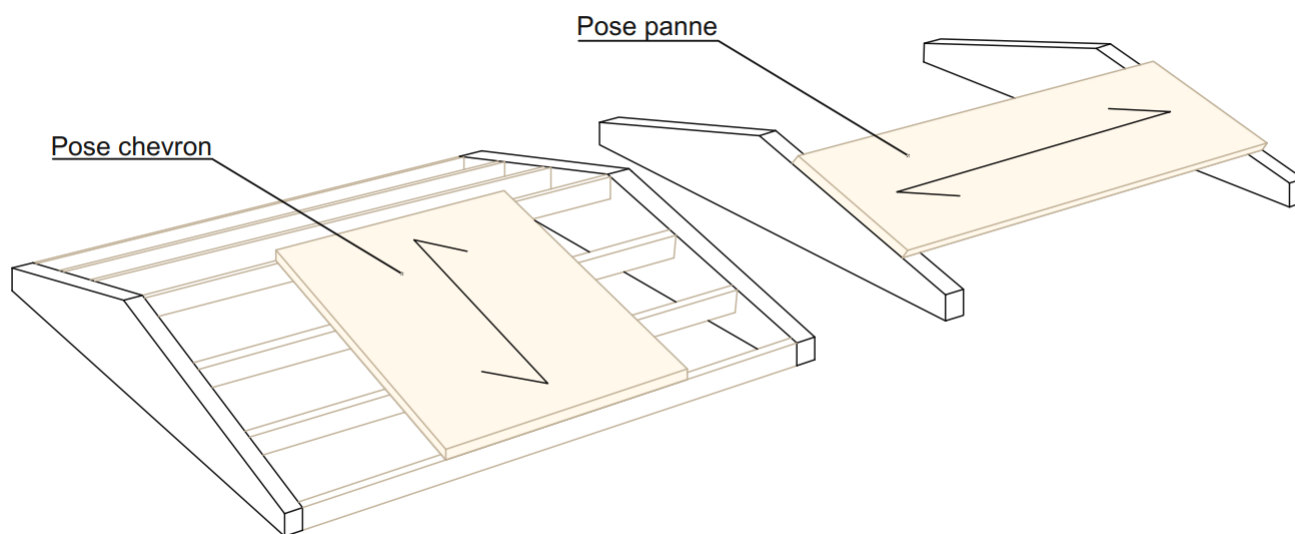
Type de pose des panneaux MM crosslam support d'étanchéité
